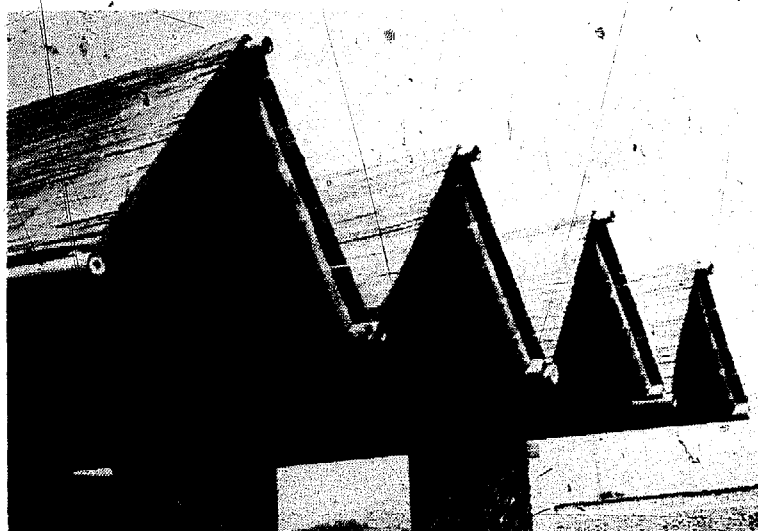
Una vez colocadas las armaduras, se procedió al recorte de los bordes de la ésterilla.
